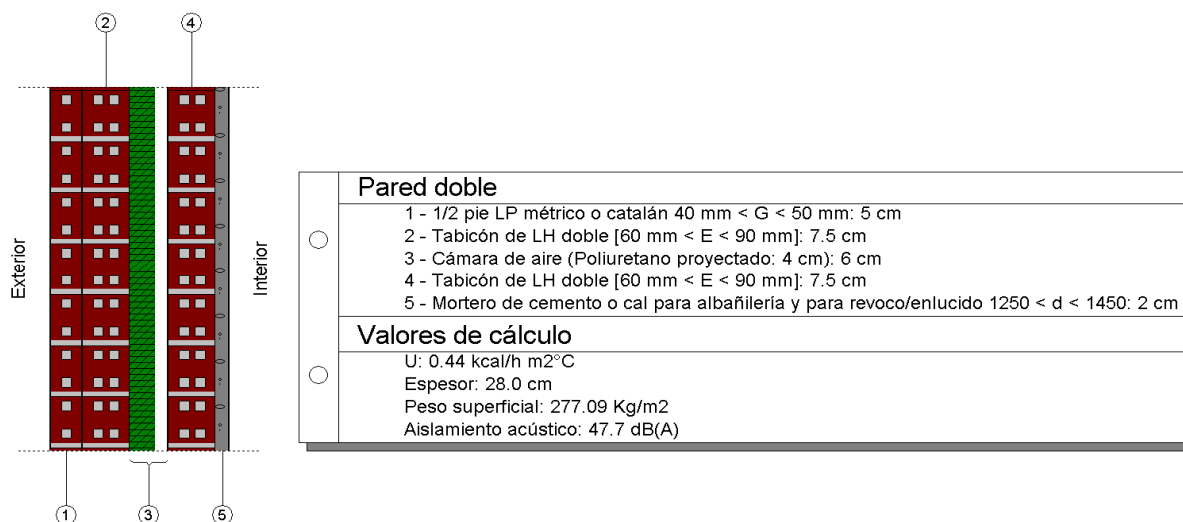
Capas del cerramiento exterior, fachada.
